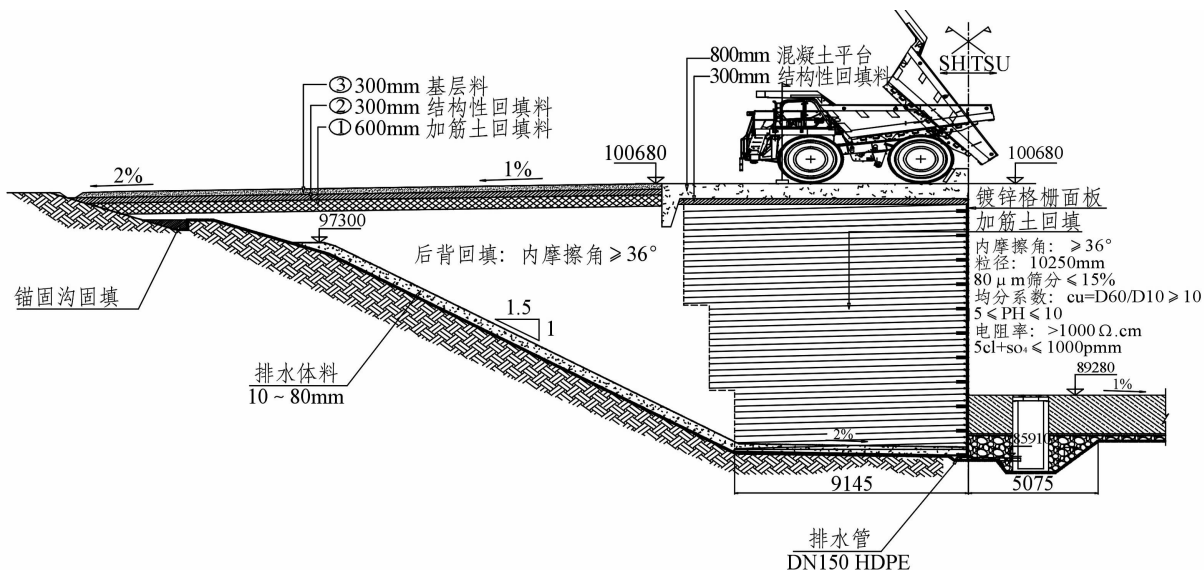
镀锌钢筋格栅面板加筋土挡土墙典型剖面图
